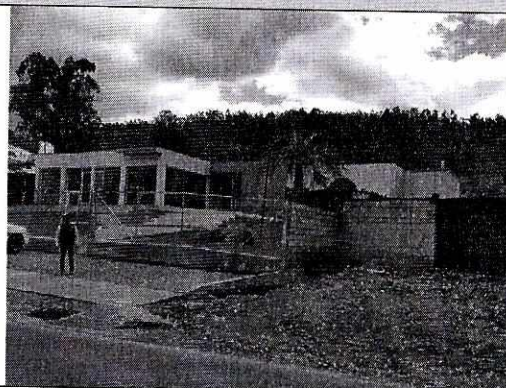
Vista de la Fachada (Edificación sin LMU -20), no se permitió el ingreso; área de infracción de 240,00m²
